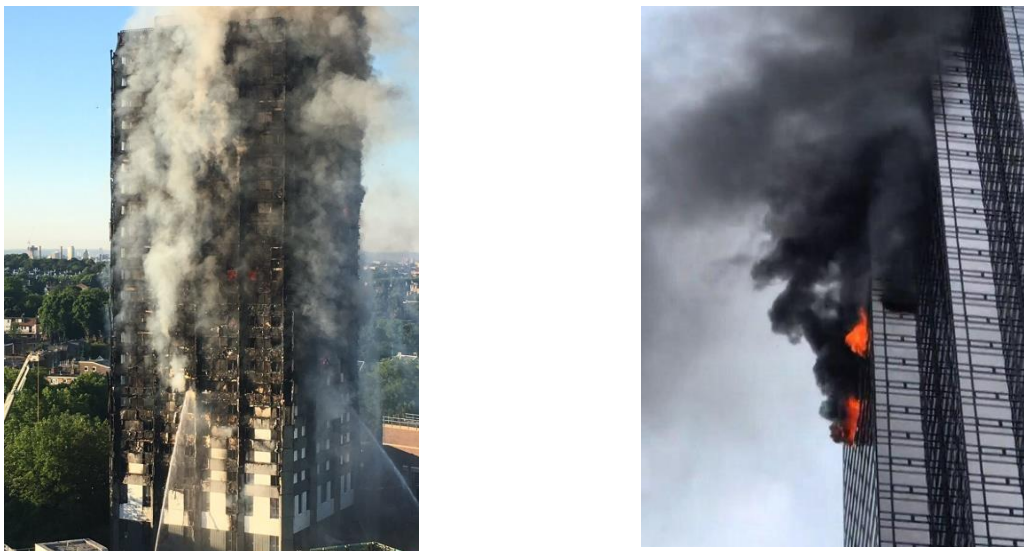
Наслідки пожеж у висотних будівлях з фасадами світлопрозорих конструкцій.
